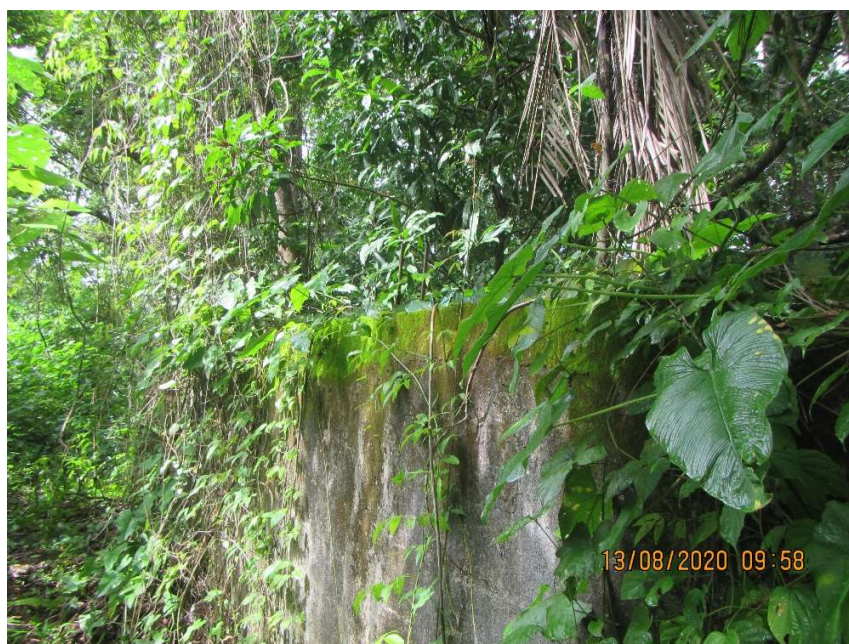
Vista del muro perimetral que antes servía de barrera para la fábrica de vidrios.
